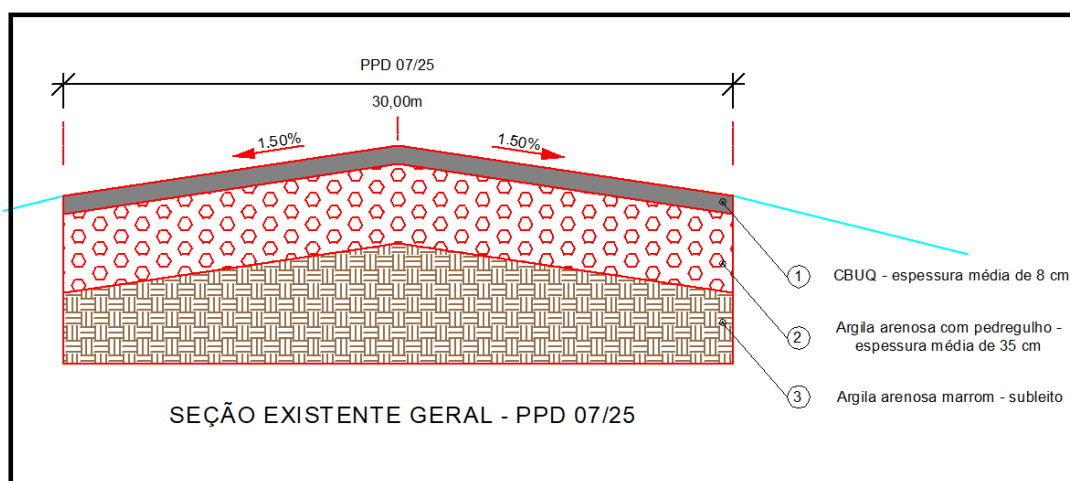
Estrutura do Pavimento - Seção PPD 25 - Existente
